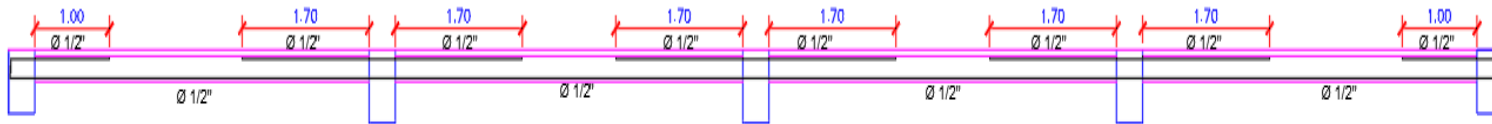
Acero Requerido en Viguetas de Losa Aligerada
